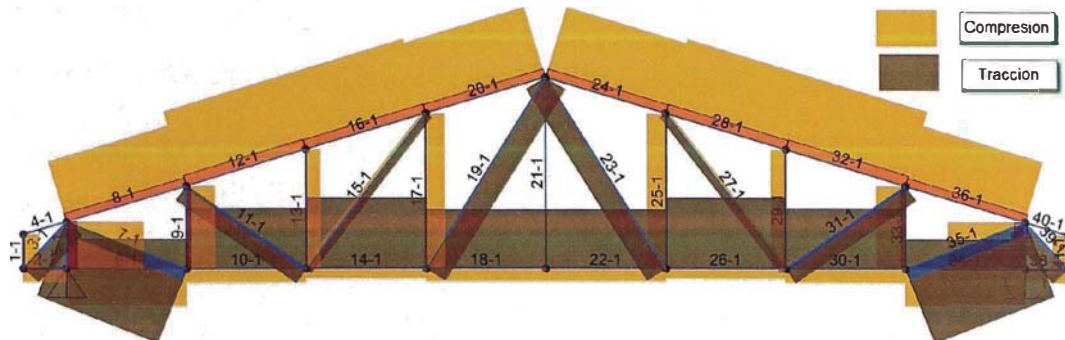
Cargas para diseño de conexiones soldadas
